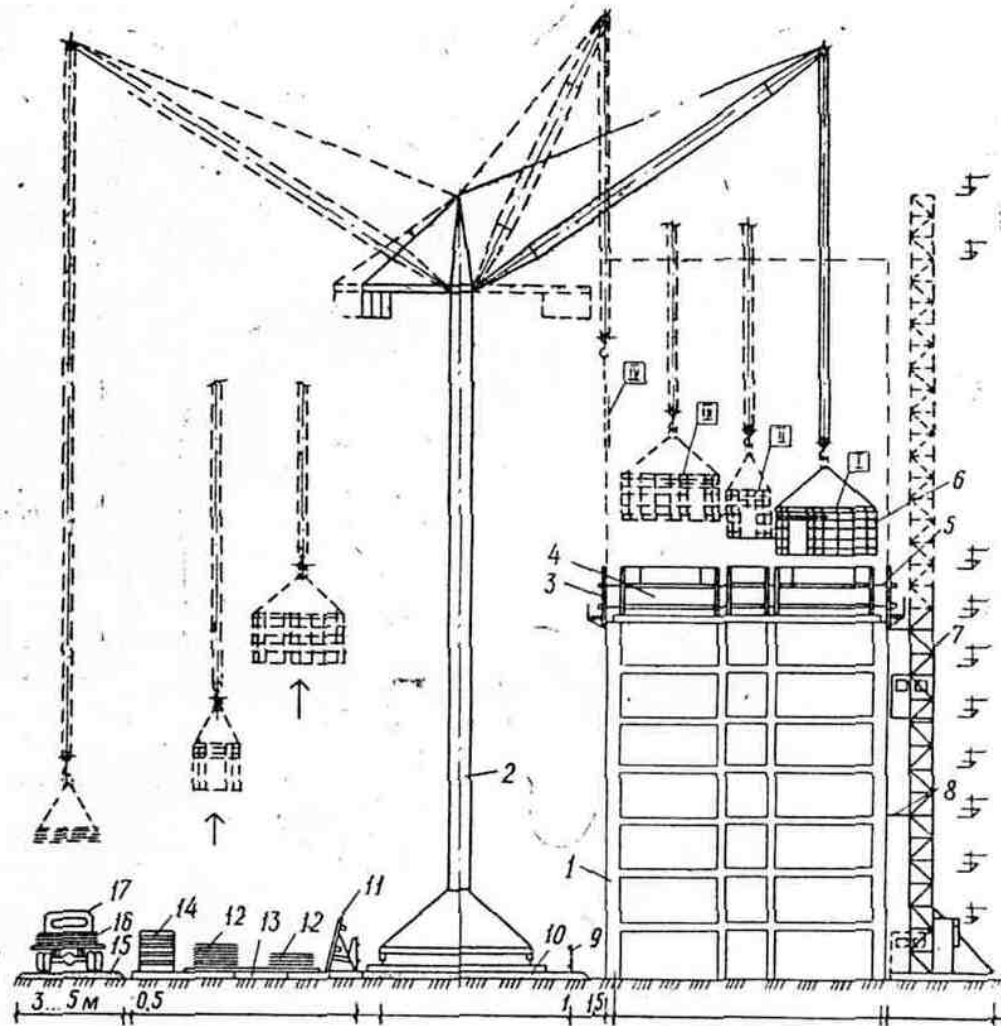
Схема монтажу арматури під час зведення багатоповерхового будинку:
